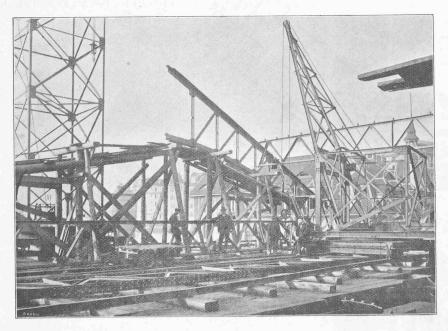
Vue du plancher de l'échafaud, au premier plan la grue basculante et pivotante.
